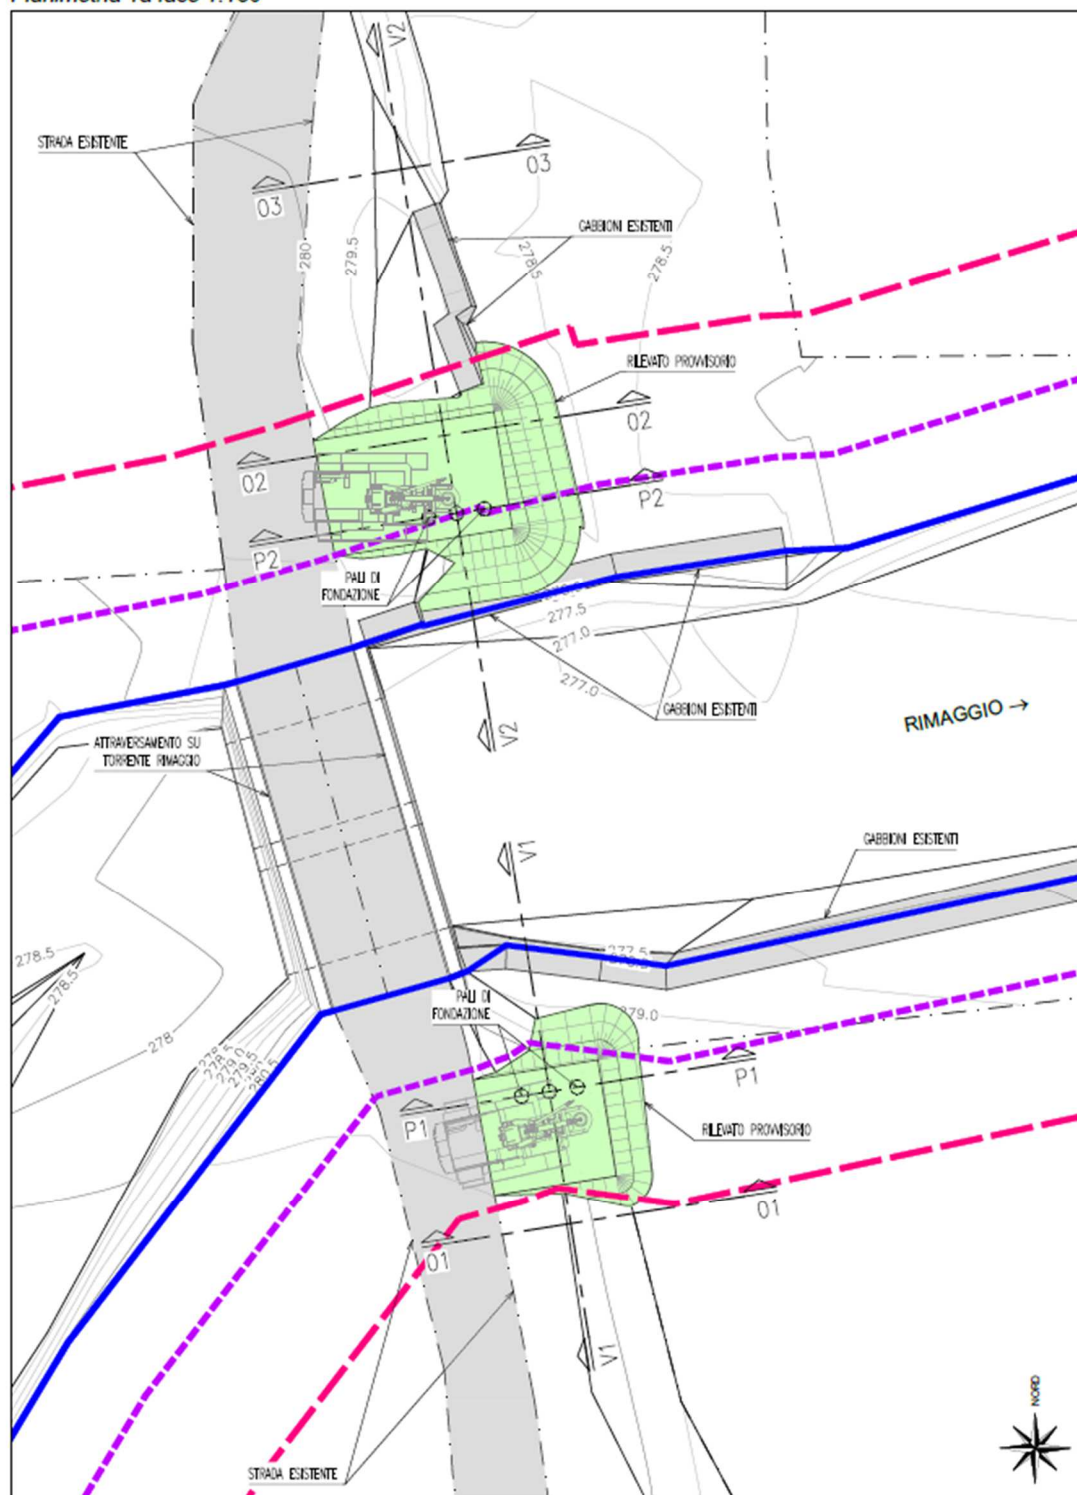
Posizionamento della macchina per pali per la costruzione delle fondazioni del nuovo attraversamento tubiero. Da R36305\_GCVI10
